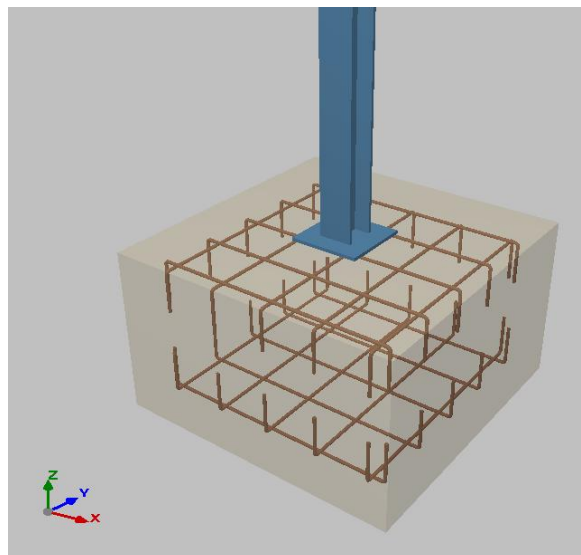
Perspectiva de la disposición de las armaduras en una zapata (Fuente: CYPE 2019).
